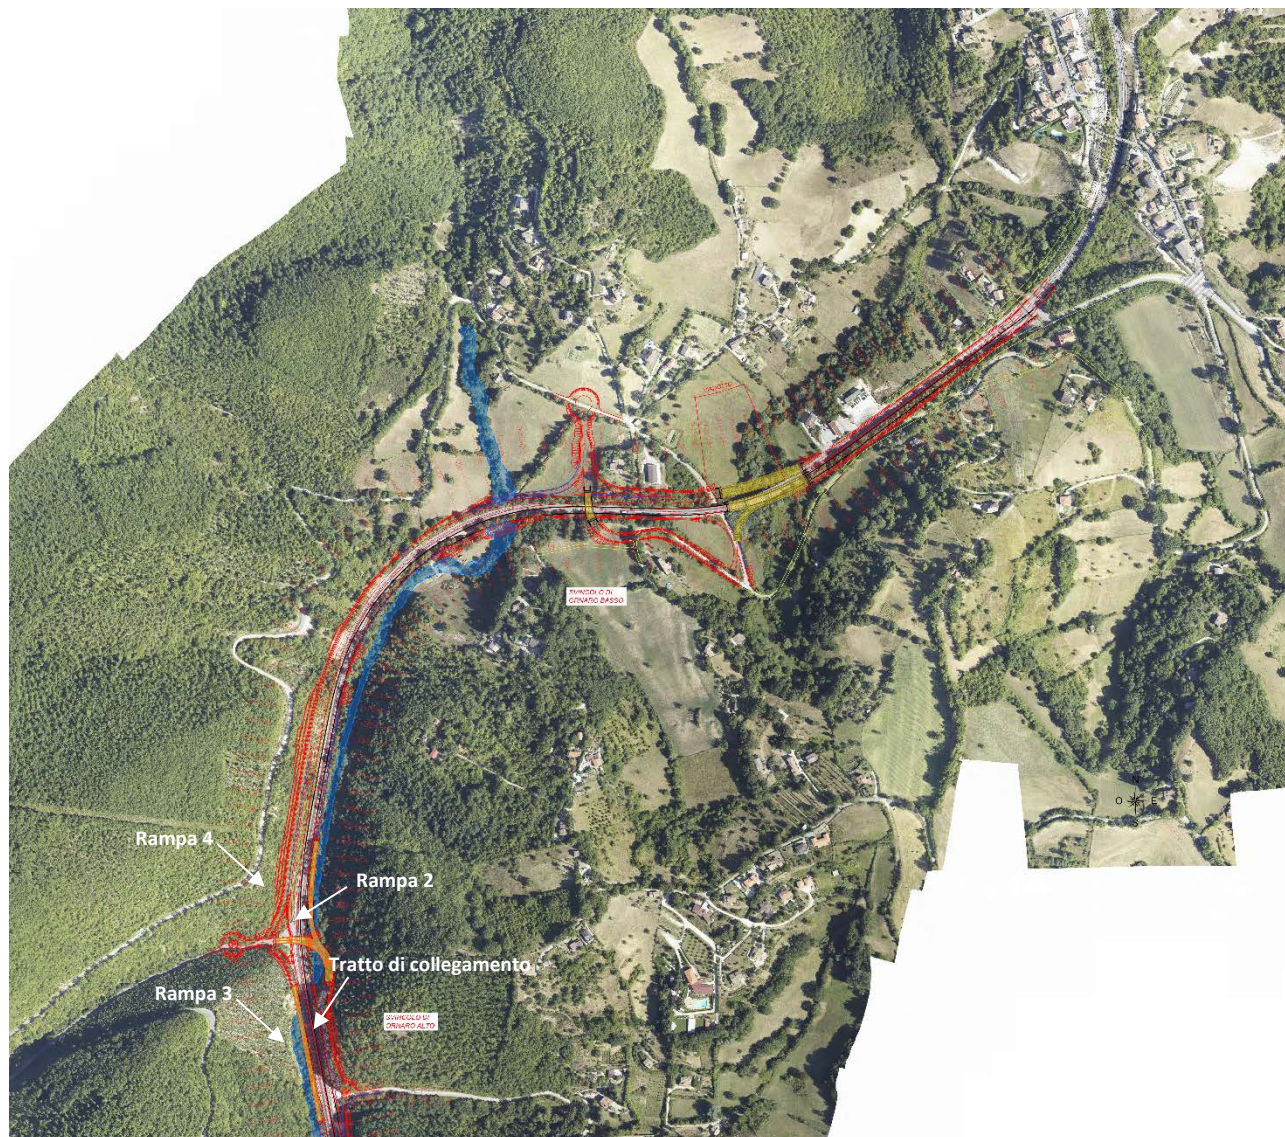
Lotto 1: tracciato di progetto su ortofoto dalla pk 6+300 alla pk 7+970
